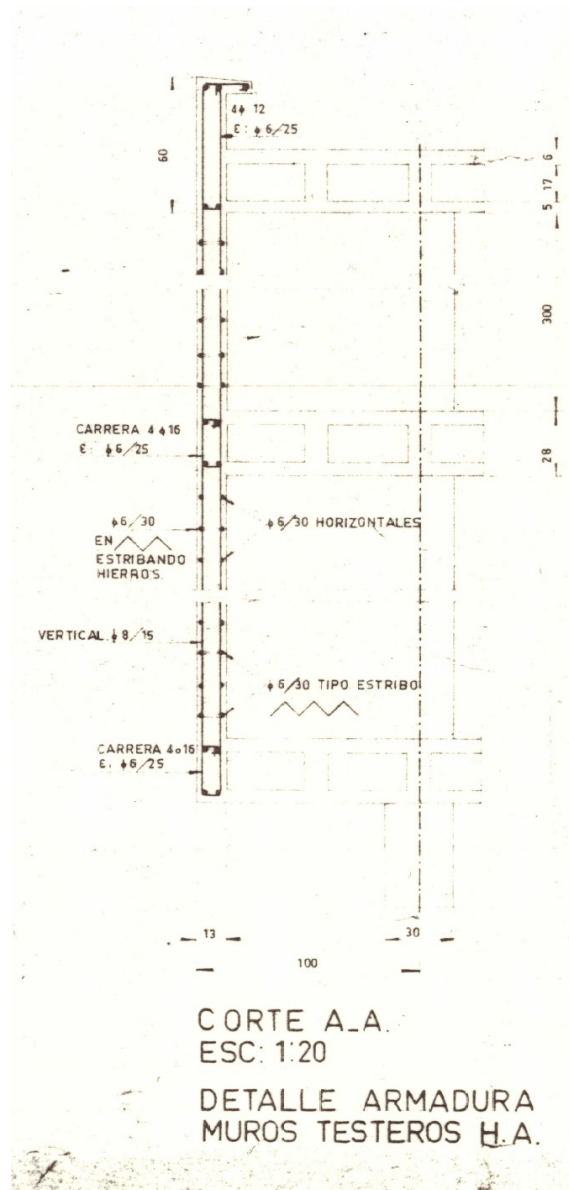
Detalle de sección transversal del muro, donde se observa la armadura del mismo. (Fuente: Planos de estructura)
